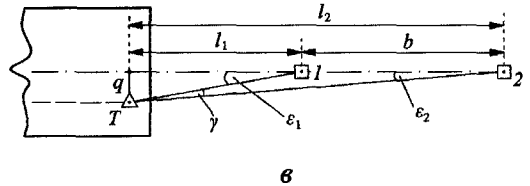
Схема передачі осей на перекриття будівлі способами:
